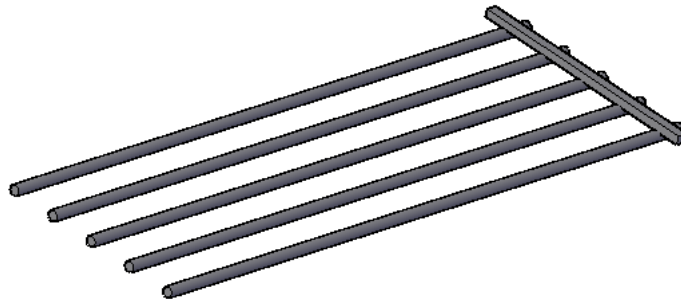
Posibilidad de anclaje 1, perfil transversal.
